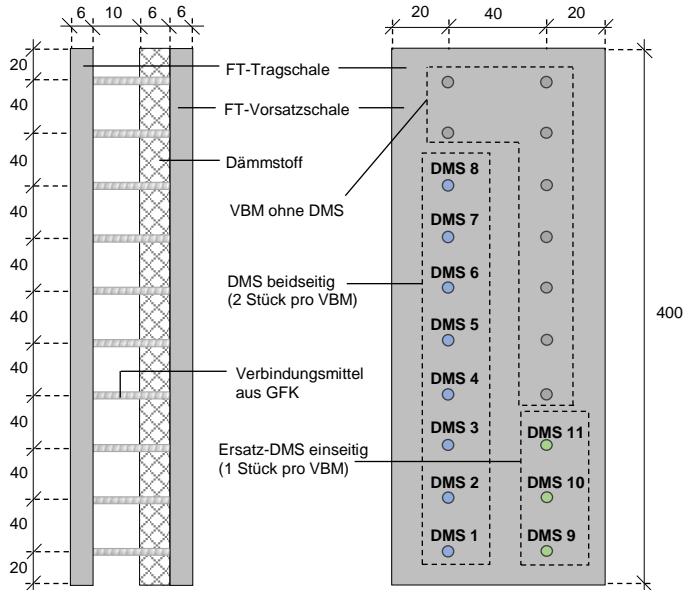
Querschnitt (links) und Ansicht (rechts) der hohen Elementwände HE01 und HE02
